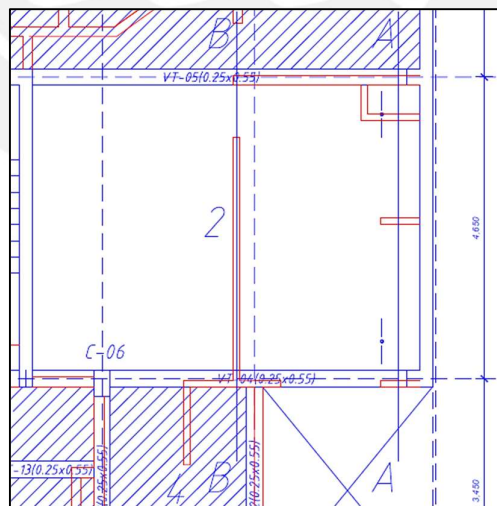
Plano en planta losa aligerada Y-Y ejes D-F/5-6
